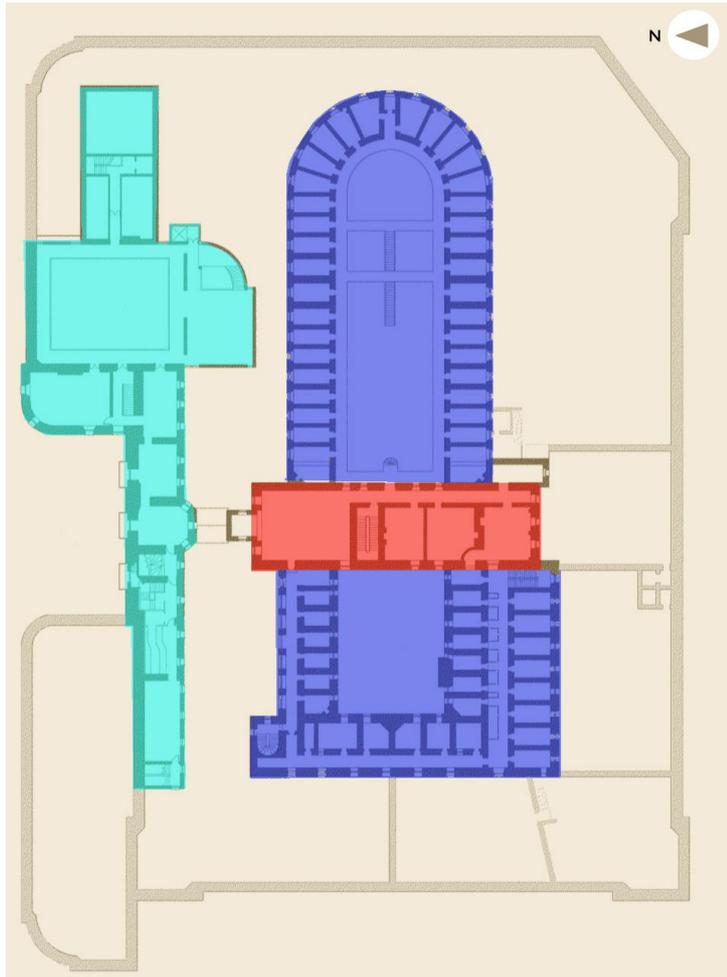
Vista en planta de la cárcel de Kilmainham Fuente: Propia
